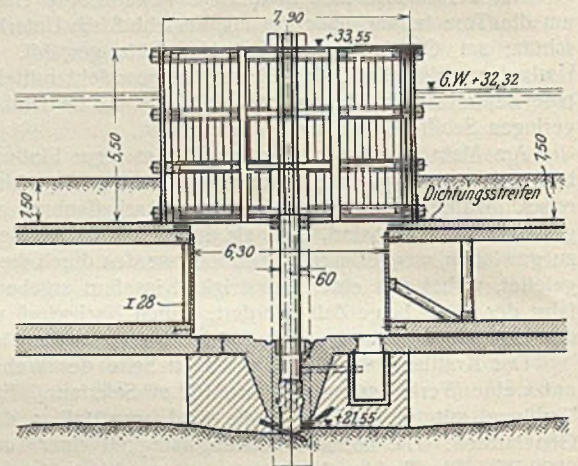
Schluß der Baugrube für den Bauabschnitt III.
